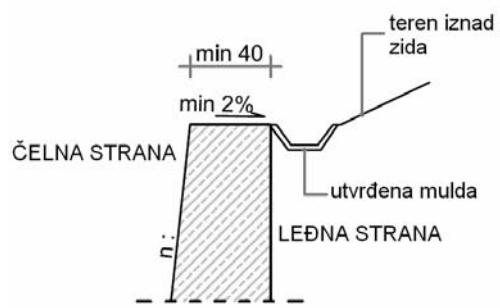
Detalj betonskog zida sa naknadnim oblaganjem
